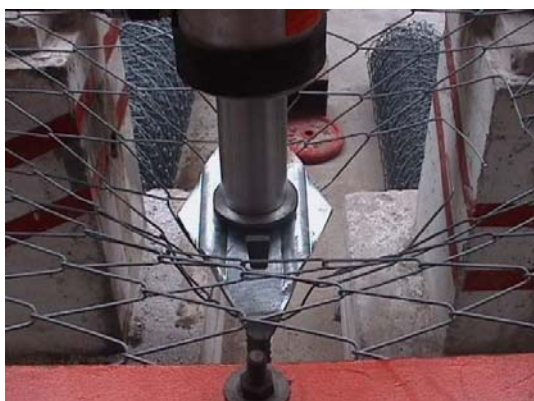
Detalle del ensayo de punzonamiento para malla TECCO Mesh G-65
